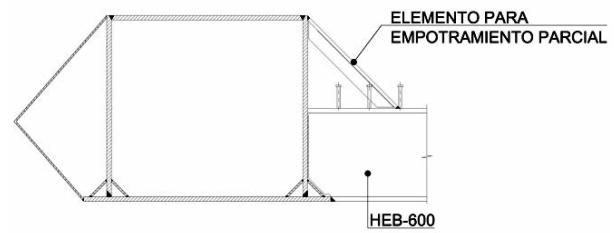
Detalle del empotramiento parcial de las vigas transversales en la viga longitudinal
